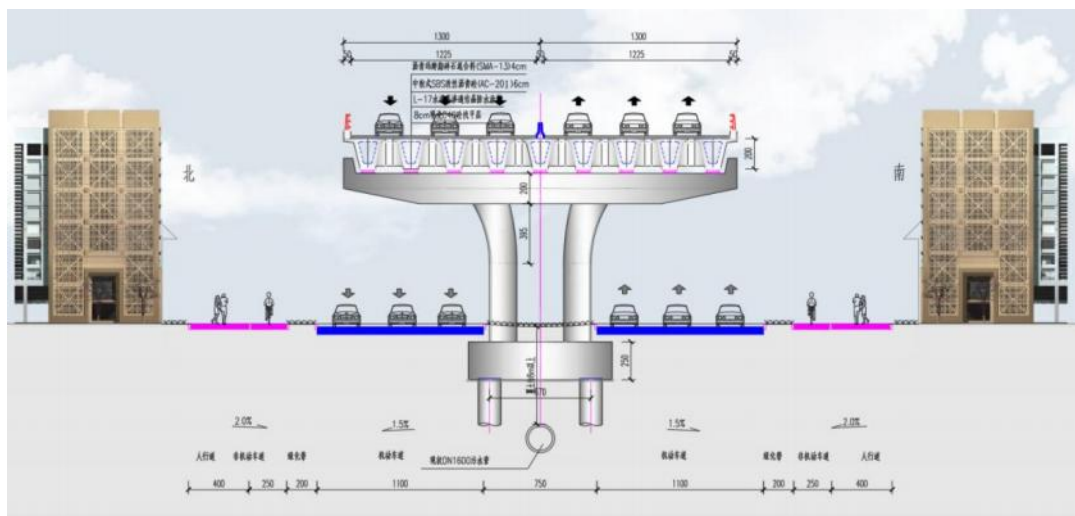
标准段主线桥断面图（桥宽 26m，预应力混凝土小箱梁）
